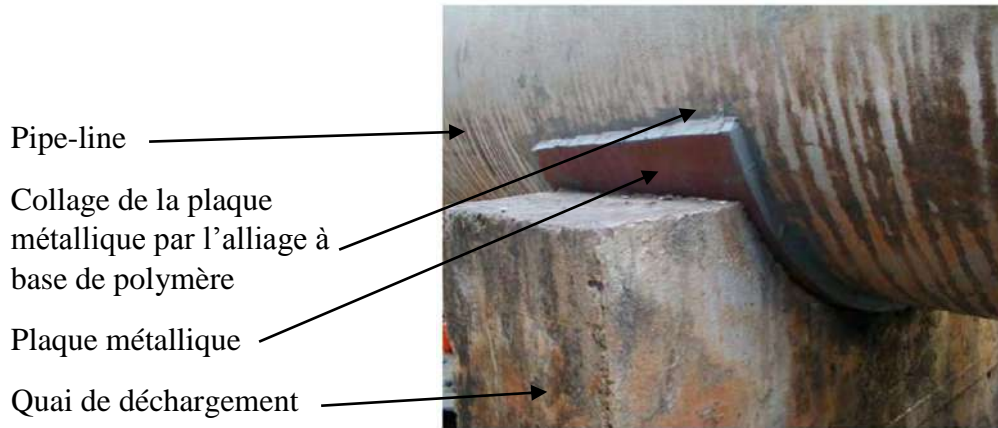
Renforcement & protection (Pipe-line pétrolier)[11]
